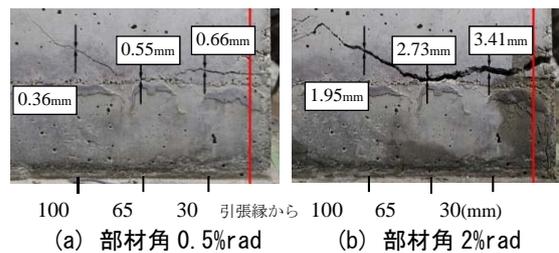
画像解析によるひび割れ幅算出(接合部有)
